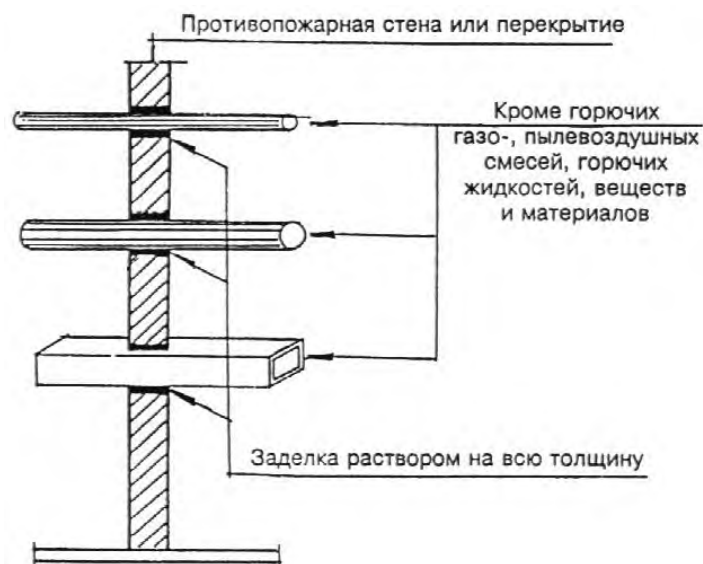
Пересечение противопожарных стен, зон и перекрытий 1-го типа каналами, шахтами, трубопроводами
